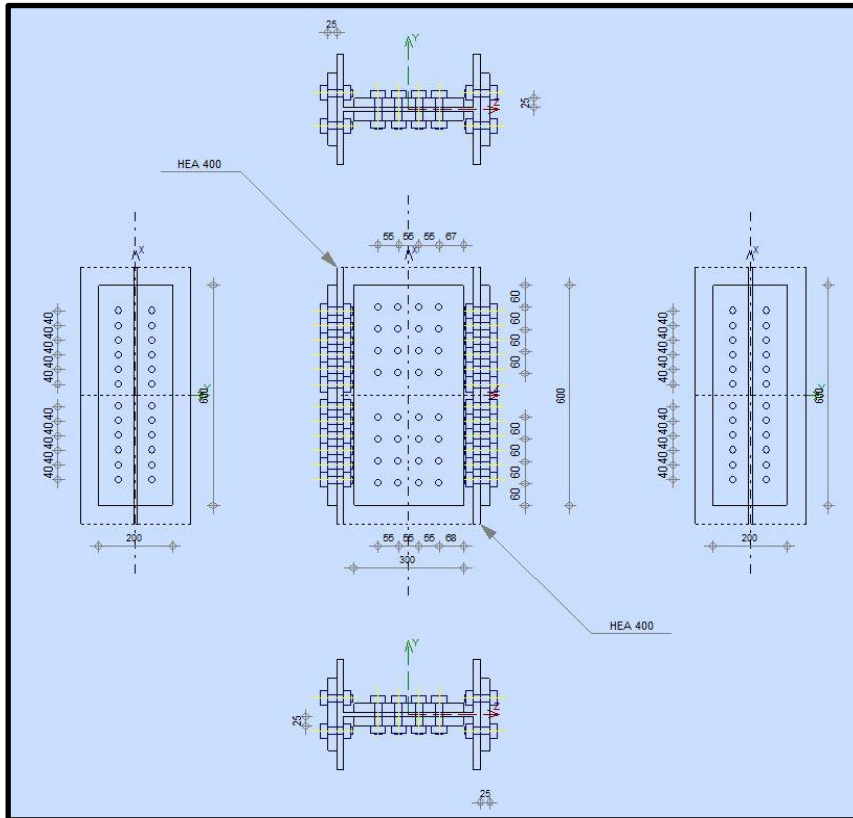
Schéma d'assemblage poteau HEA 400 – poteau HEA 400
